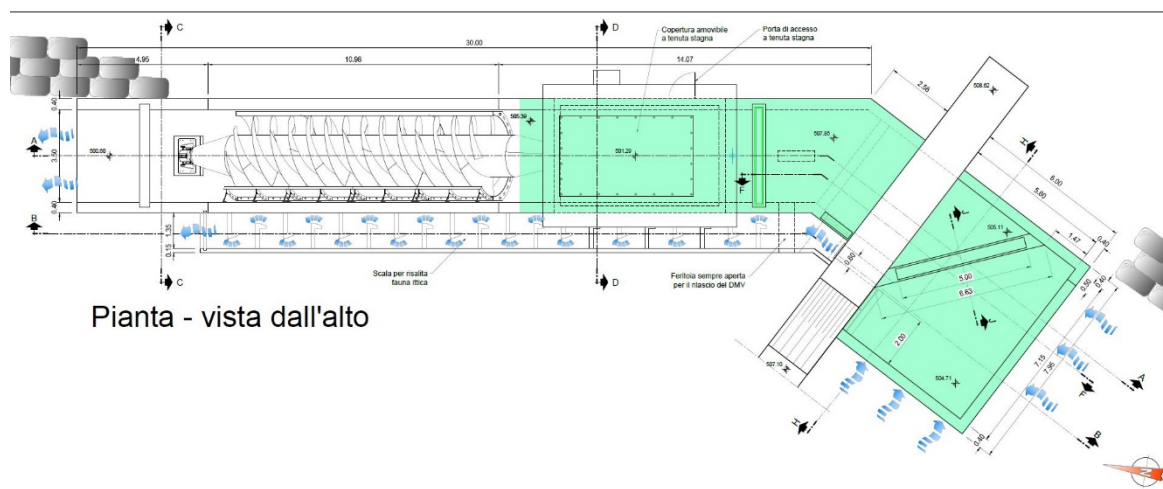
a: Pianta Stato di fatto (verde) – stato di progetto
